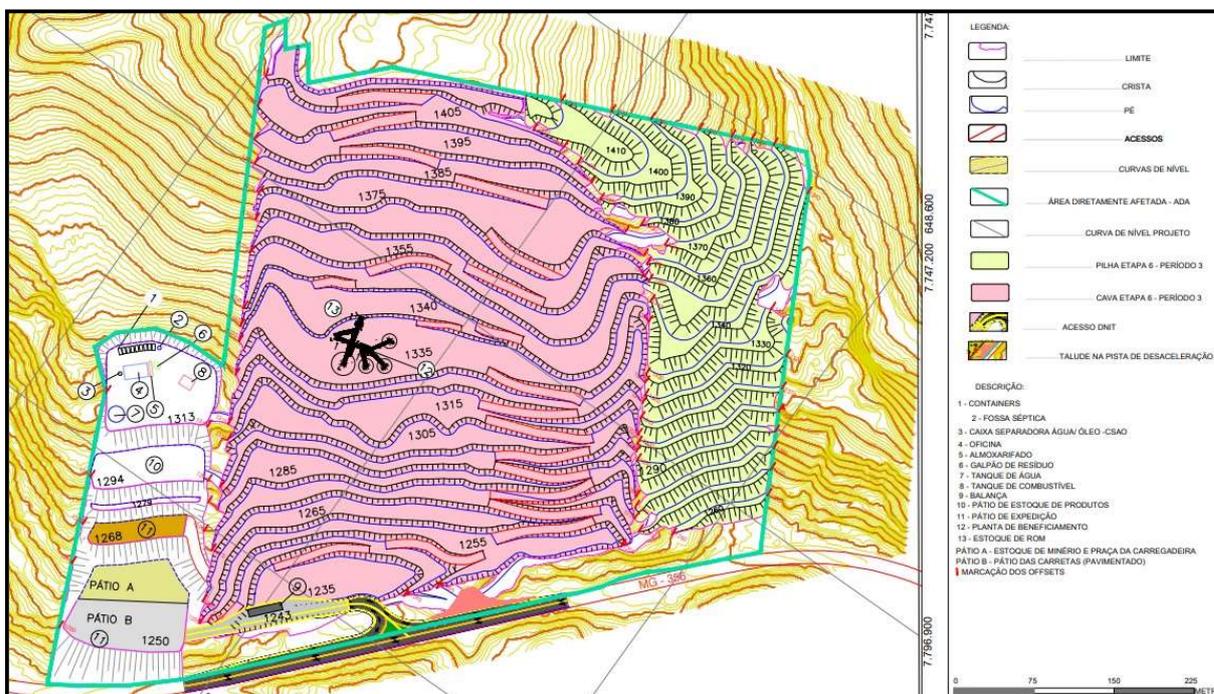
Planta planialtimétrica do projeto Patrimônio, identificando a conformação final das estruturas da Pilha de rejeito/estéril, área de lavra, pátios e acessos. Fonte: Autos do PA.
